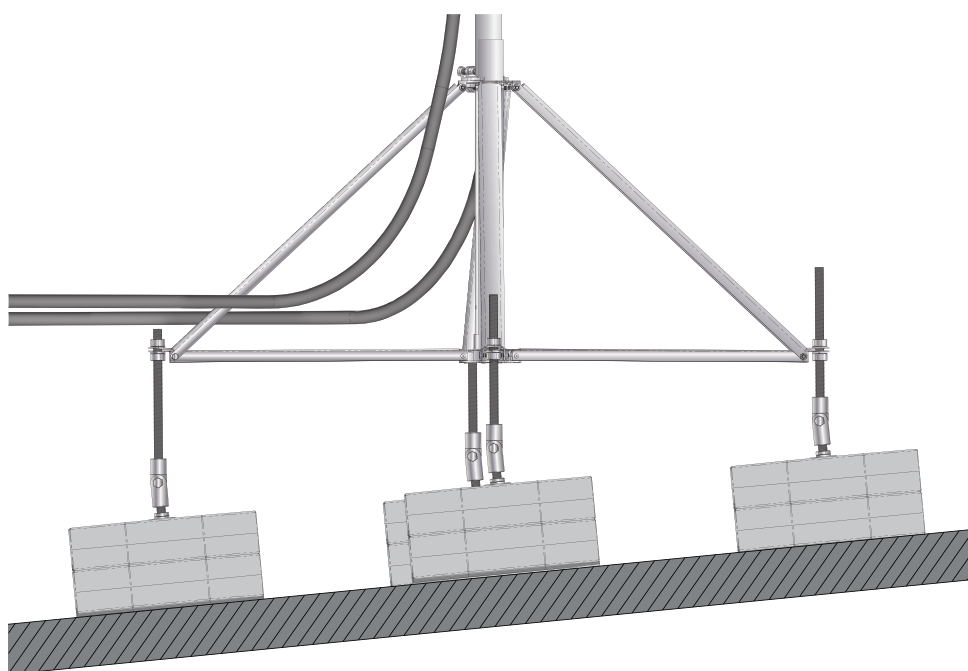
Disposizione dei blocchi di calcestruzzo su una posizione inclinata
